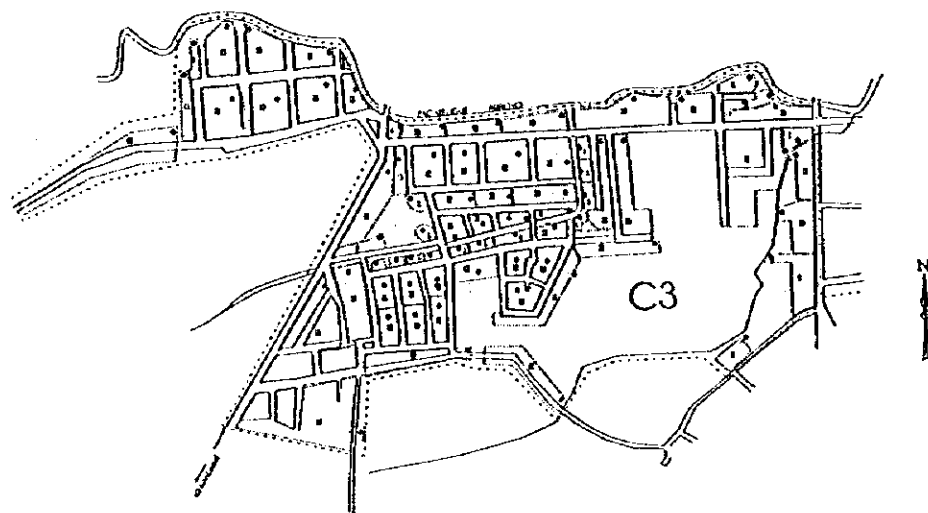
Plan de Distribución de los Sistemas *In-Situ
